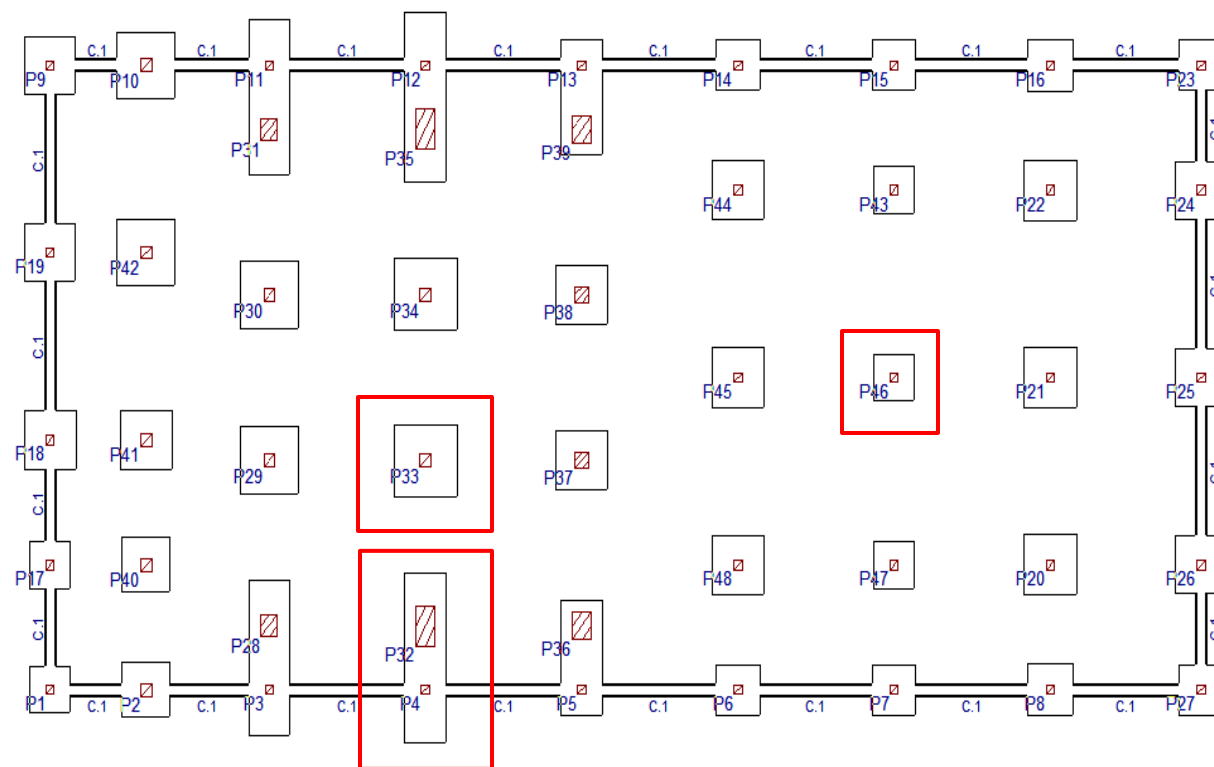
Localización en planta de las zapatas objeto de dimensionamiento. (Cype)
